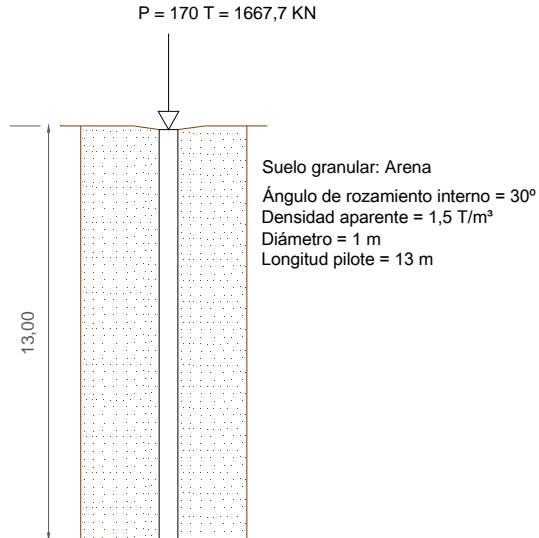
Croquis de pilote con diámetro 1 m y longitud pilote 13 m
